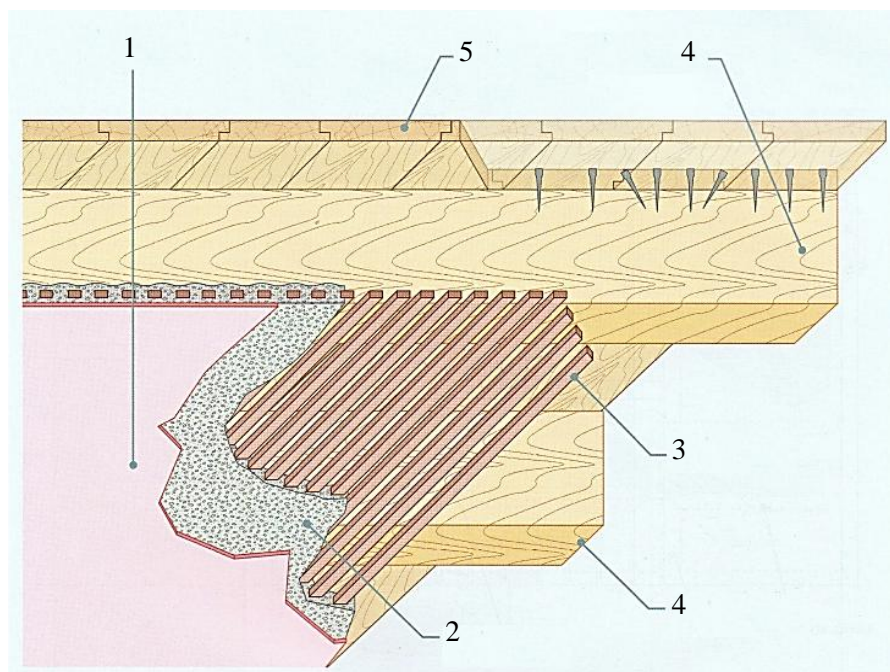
Vigas do pavimento (Appleton & Domingos, 2009)
